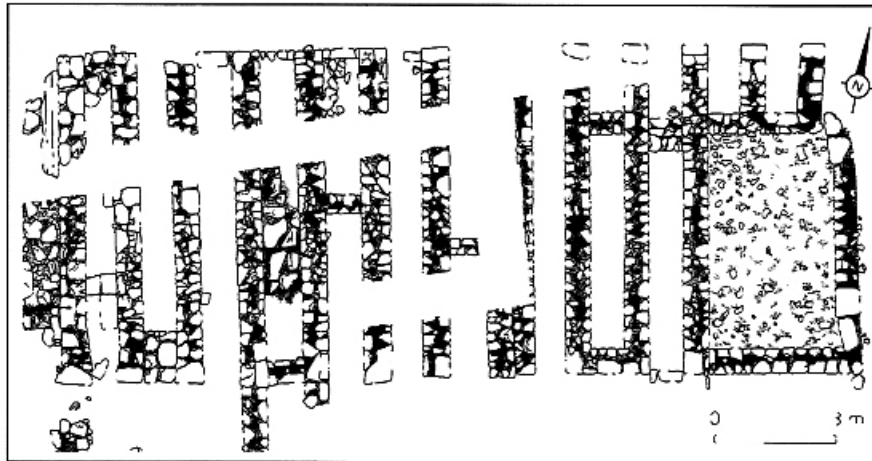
Planta do celeiro A - primeira fase, B - segunda fase. Desenho de Severino Rodrigues
